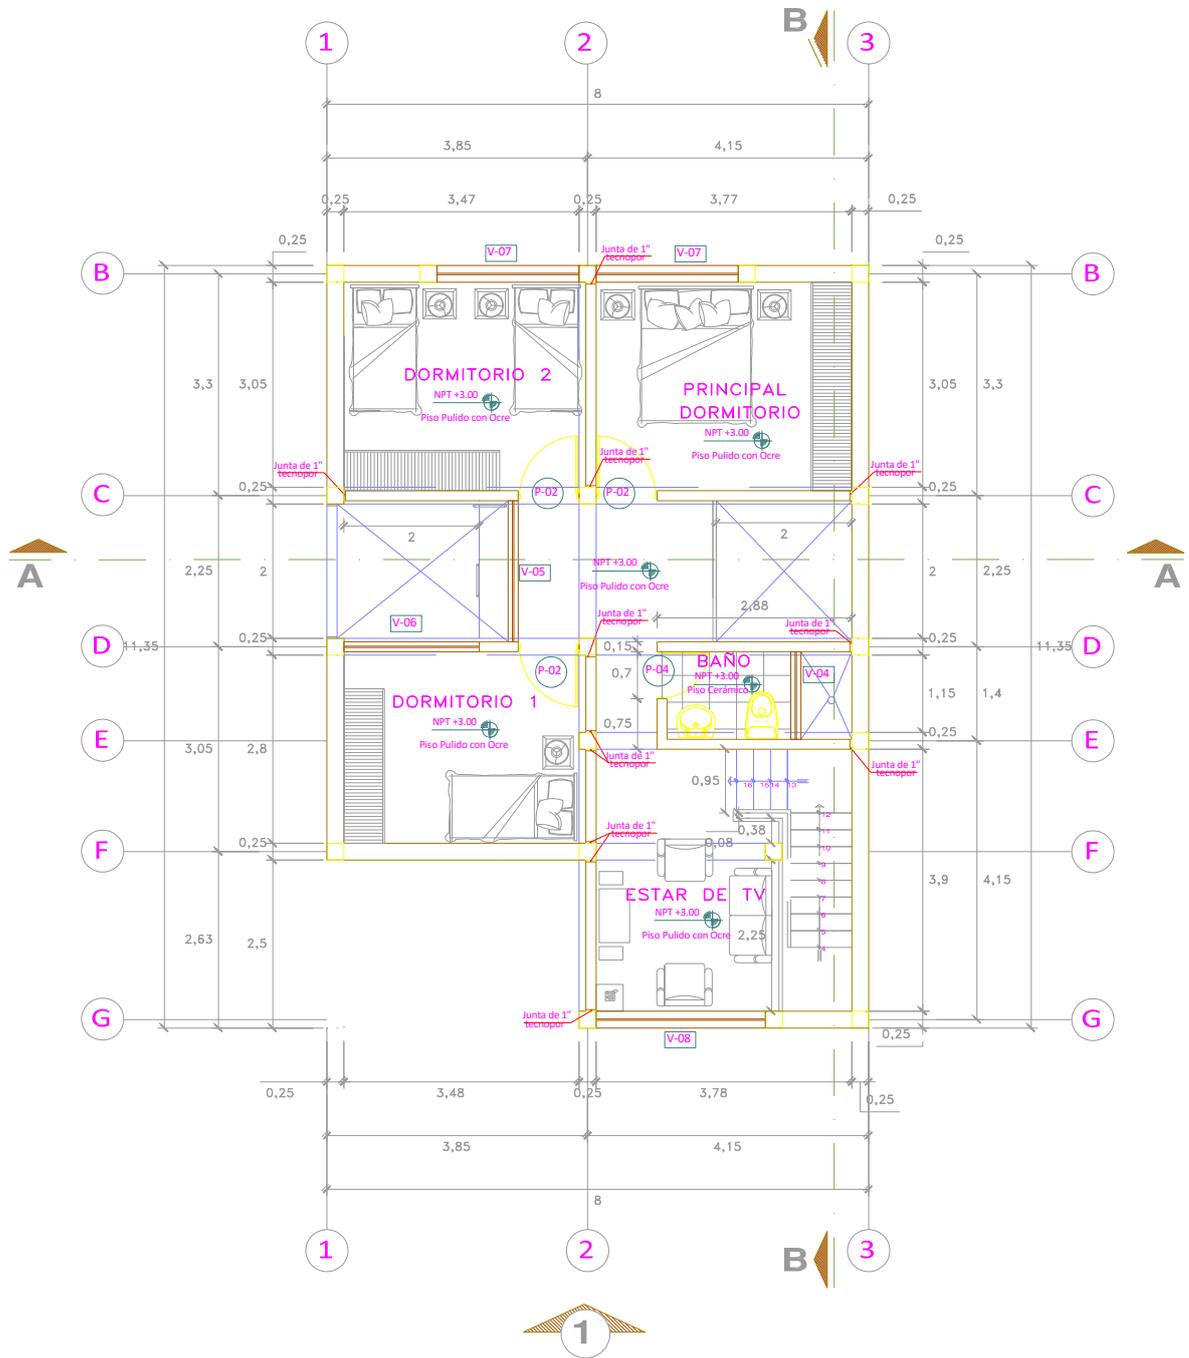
Vista en planta Vivienda Segundo piso.
